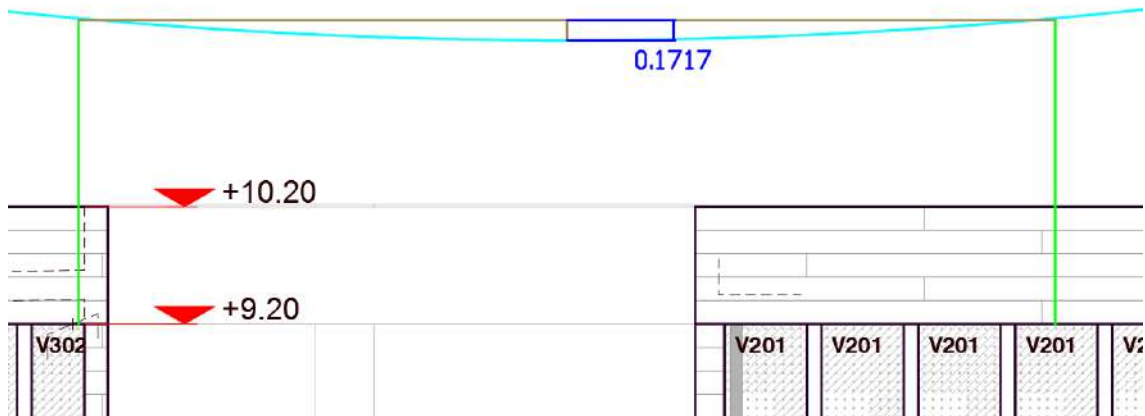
Detalle de la vista de elevación de la imagen 107.
